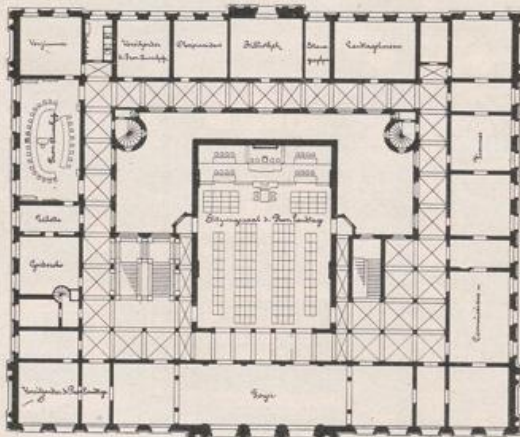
Grundriss des 1. Stockwerks. 1 : 800.
